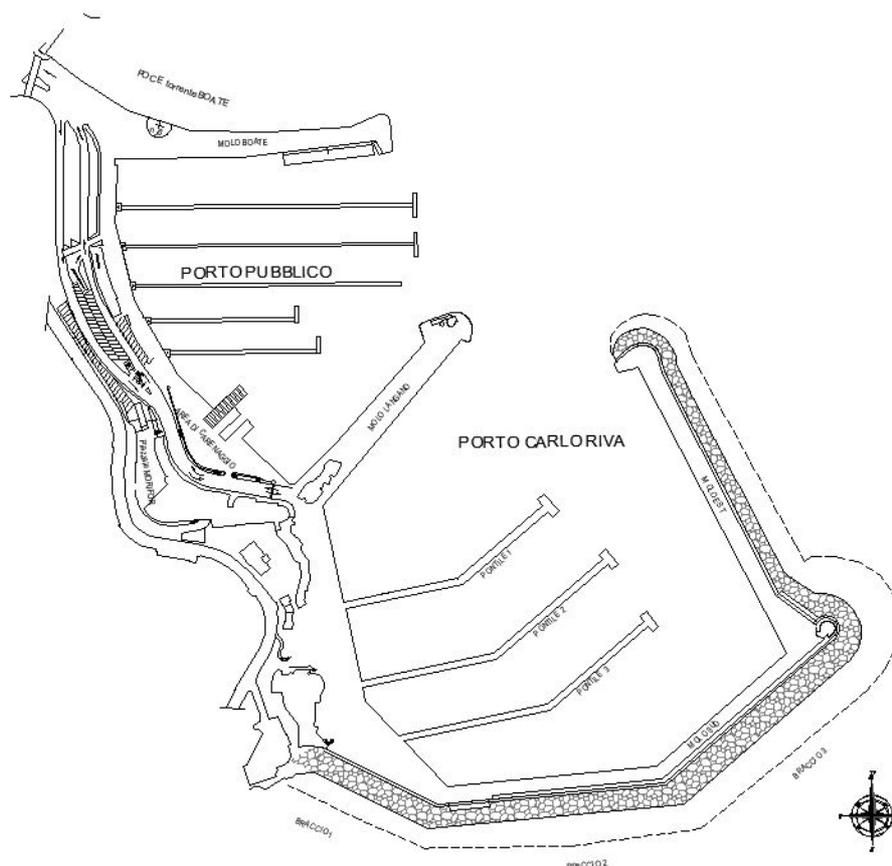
Planimetria generale del Porto di Rapallo
